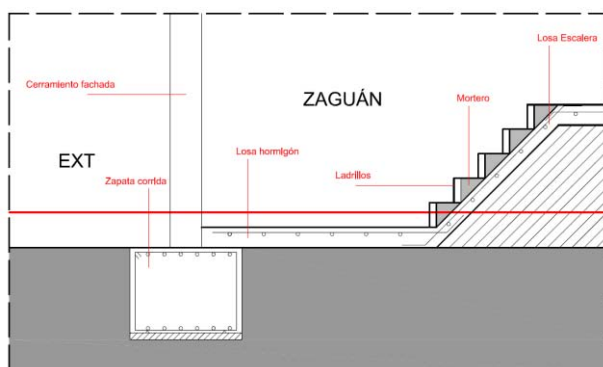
Detalle cimentación [Anexo II. Planos]
